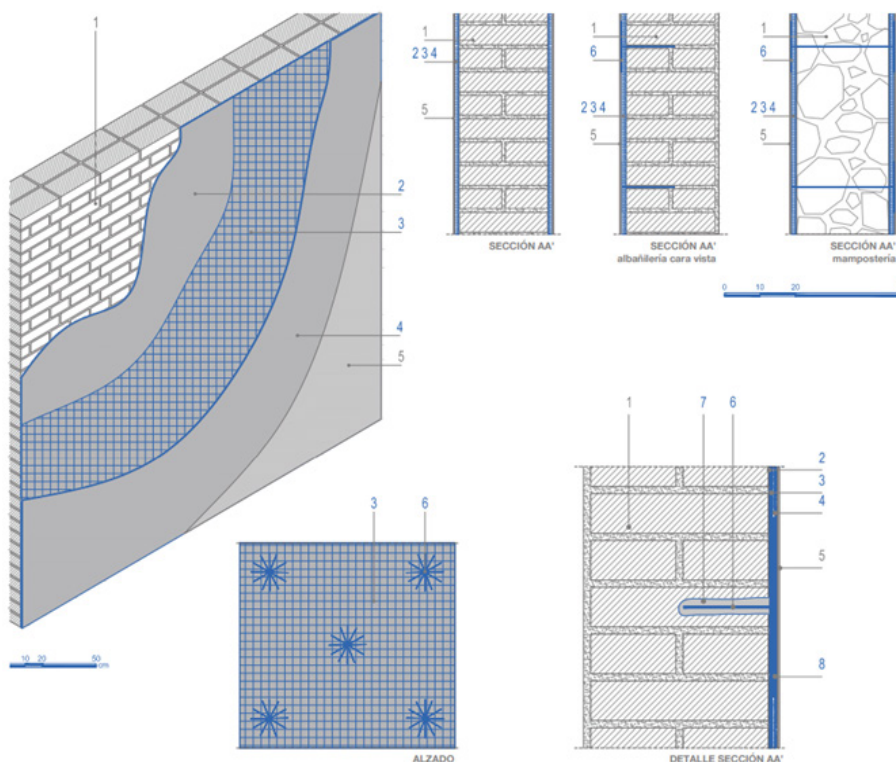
Detalle constructivo de la técnica de refuerzo frente a acciones fuera del plano y en el plano de fachada con revocos de bajo espesor, MAPEI (22)
